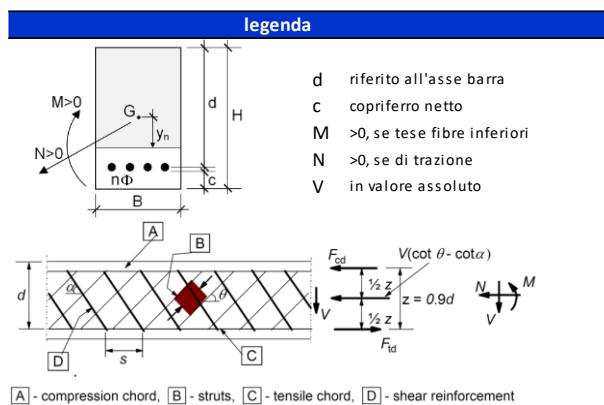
Verifiche allo SLU ed allo SLE di tipo STR parete di monte (sezione posta a circa 1.5 m dall'estradosso della fondazione).
